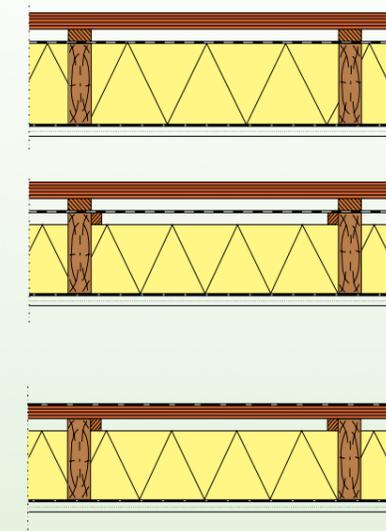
Verwendete Dachkonstruktionen im Wohnungsbau. POLMETAL GMBH – Montageanleitung – DACHPANEELLE MIT STEHFALZ
